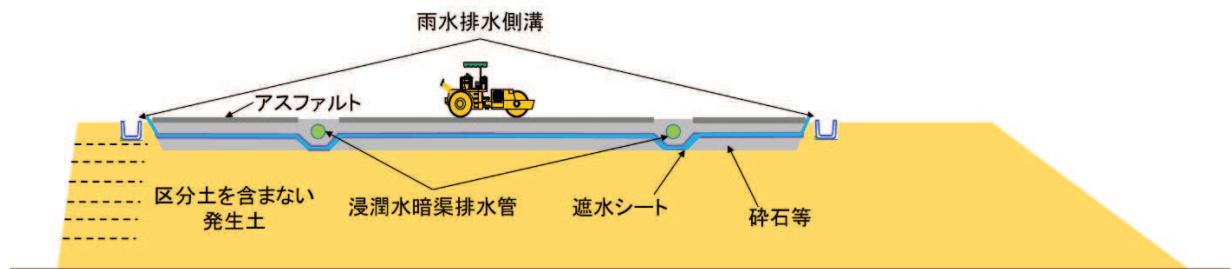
(1) 主な施工手順（アスファルト舗装施工）
